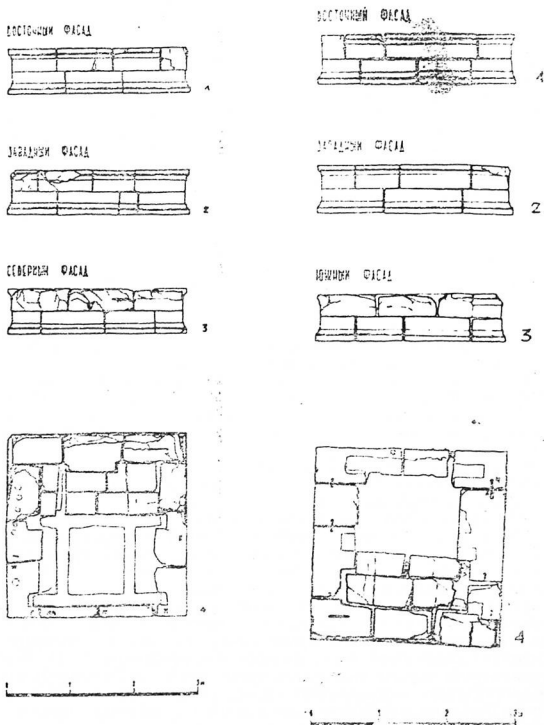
Алтарь № 1: 1) восточный фасад; 2) западный фасад; 3) северный фасад; 4) план алтаря
